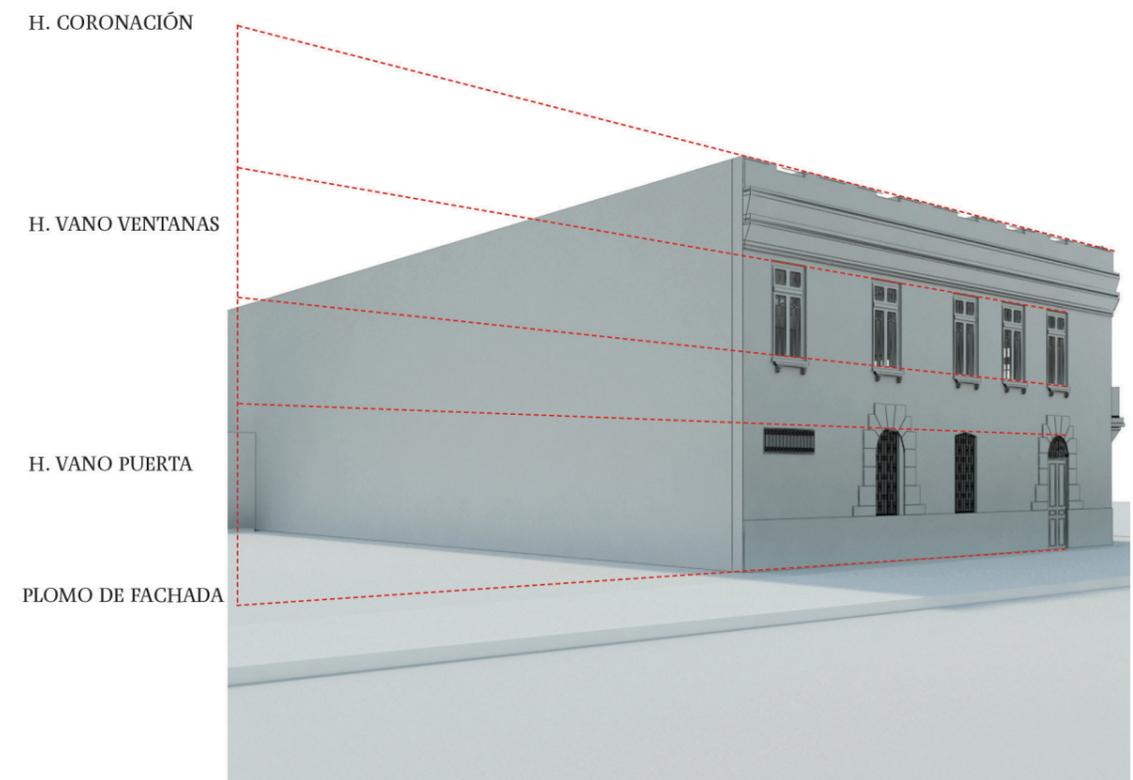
Líneas de diseño propuesta para inmuebles proyectados adyacentes a una 'casa de alto de uso mixto'. Fuente: elaboración autores.
